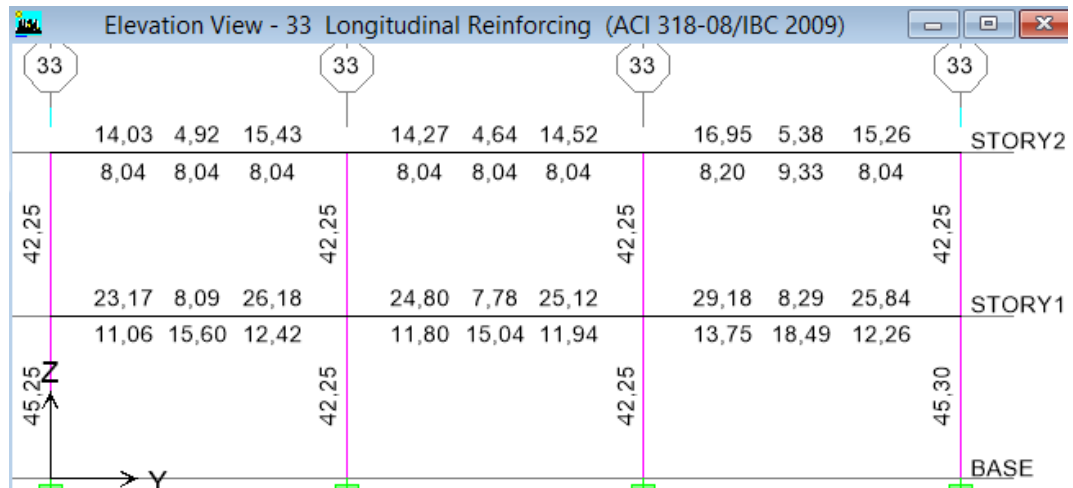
Acero en Vigas y Columnas en el Pórtico 33 – C. Quirúrgico- (NEC-11)
